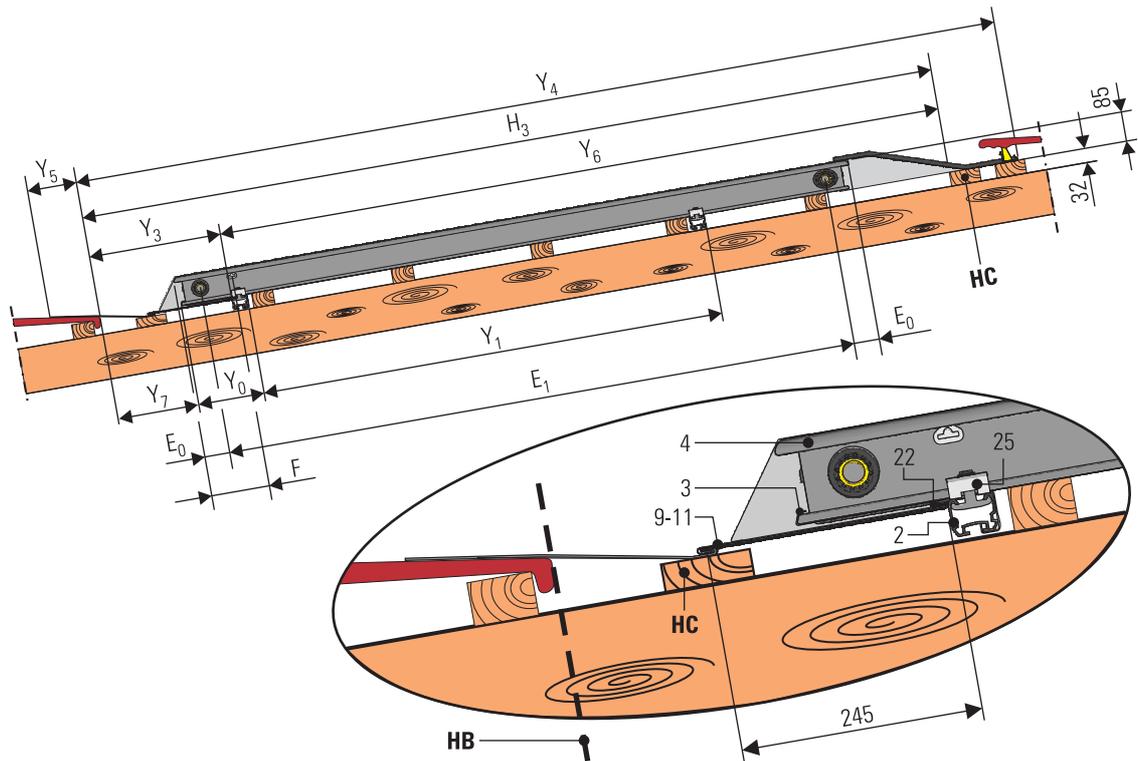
Dimensions principales d'un champ de capteurs d'Installation solaire pour un Montage intégré en toiture de capteurs solaires (représenté à l'exemple d'un capteur plan EKSV26P en système Drain Back) - Légende voir fig. 3-3. - Dimensions voir tab. 3-3.
